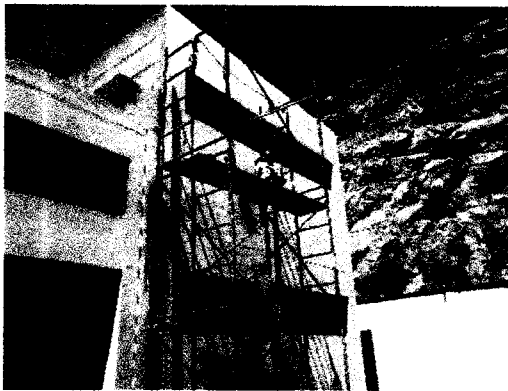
y 28: Pintado de muros, columnas, vigas y derrames con imprimante. EXTERIOR ZONA DE TAREAS PREVIAS
